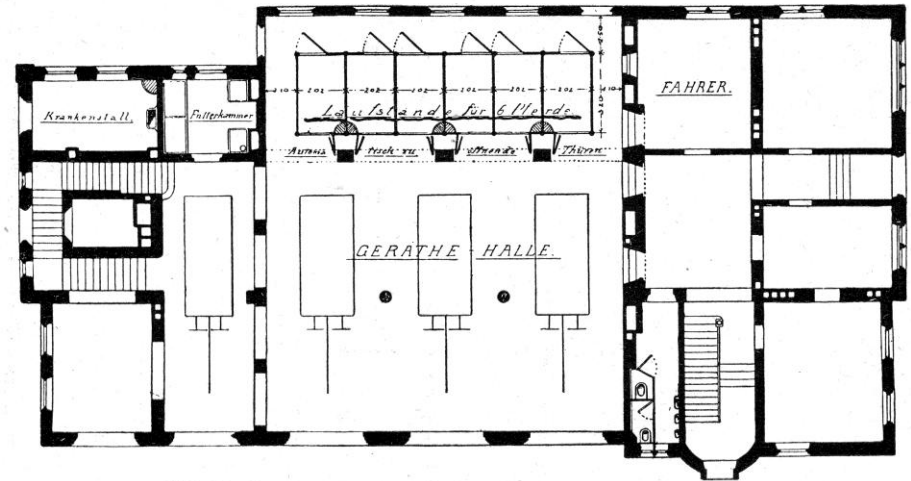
Grundriß vom Erdgeschoß der Westfeuerwache in Nürnberg.
